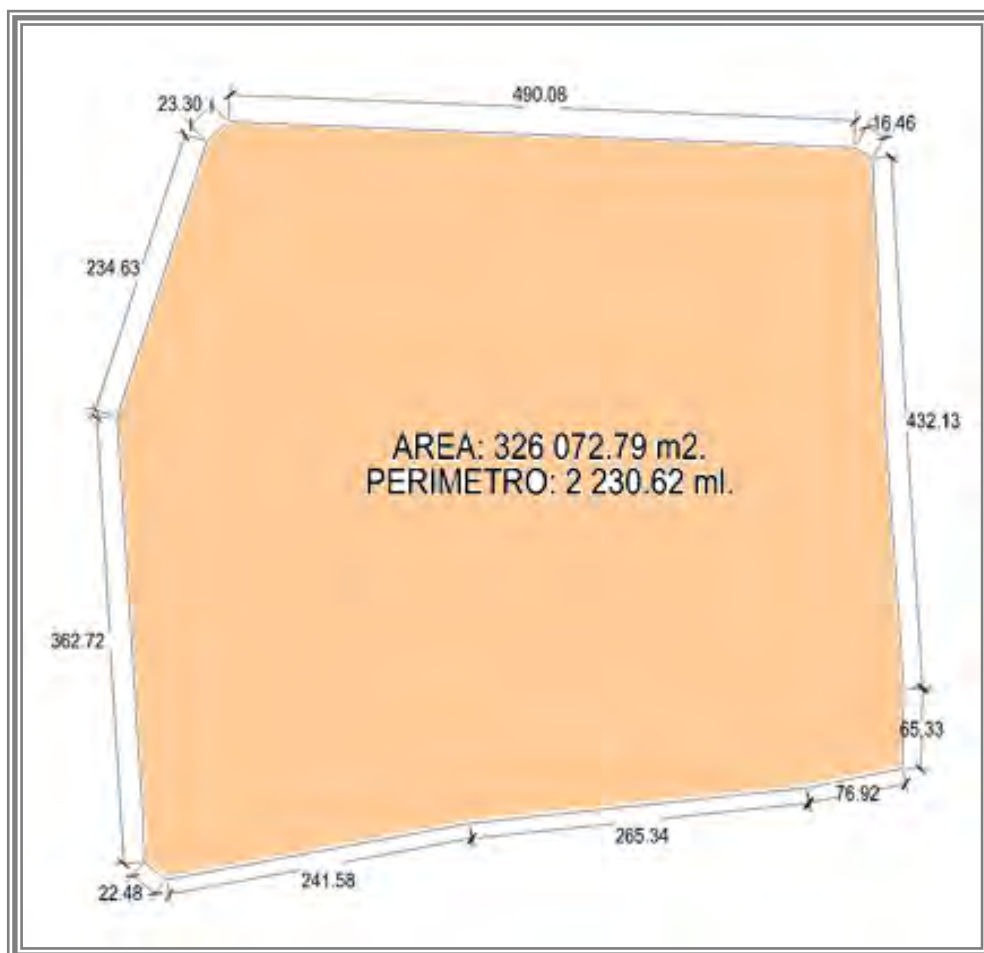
Área y perímetro del terminal terrestre de Pisco (fuente propia)
